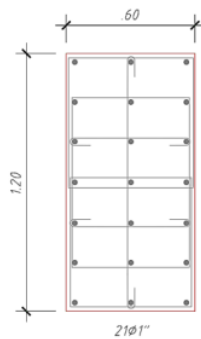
Disposición de acero longitudinal en la columna a analizar
